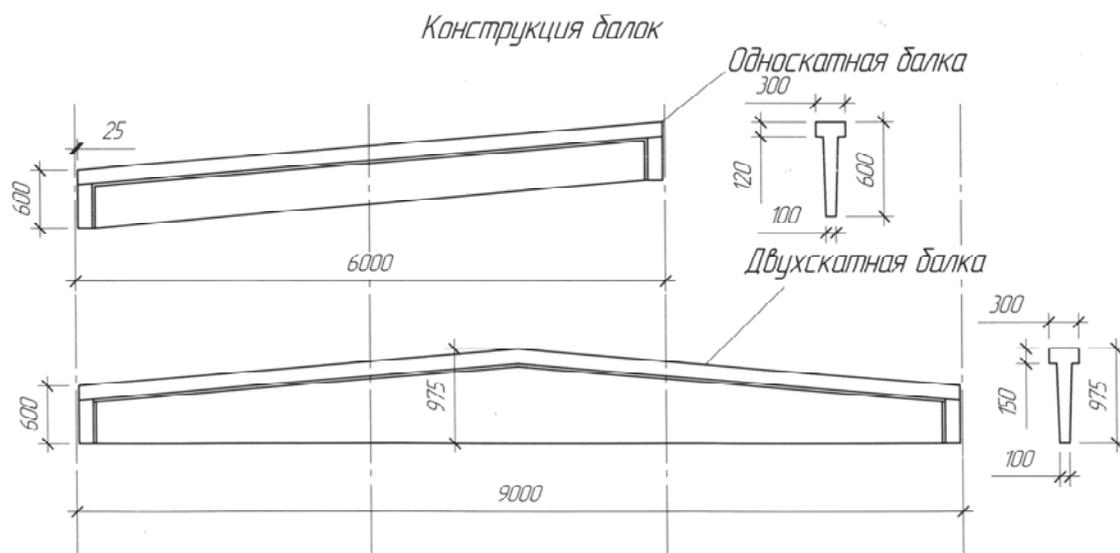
Конструкция балок скатных покрытий пролетом 6 и 9 м
